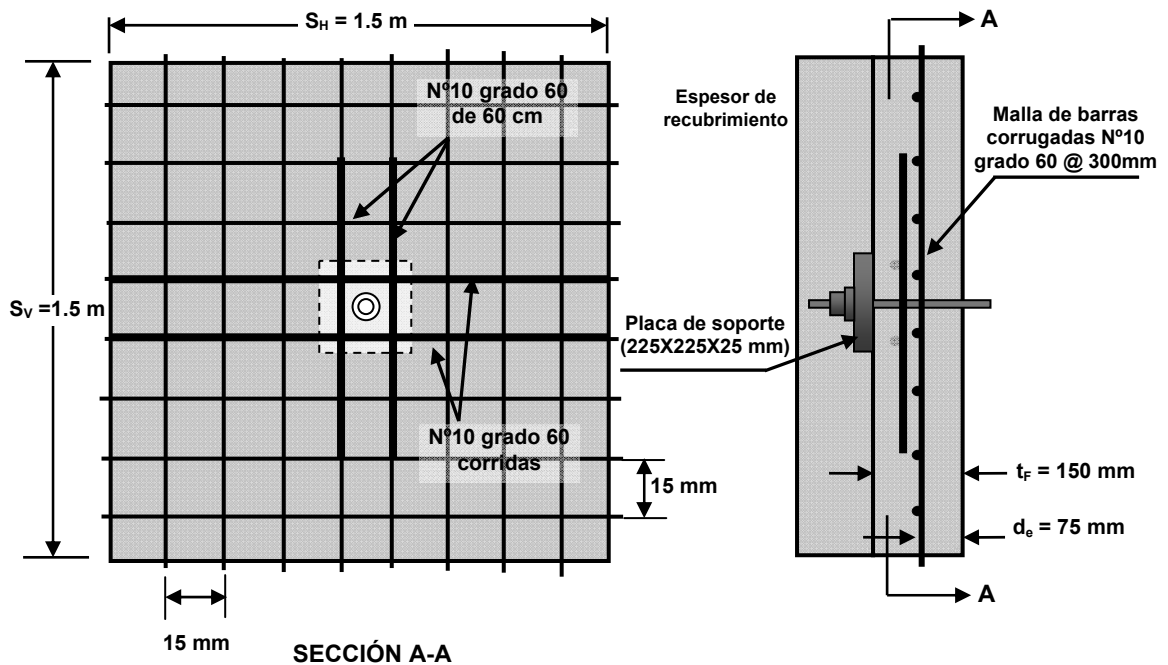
Detalle del refuerzo en la pantalla de revestimiento del muro, para una sola pantalla.
